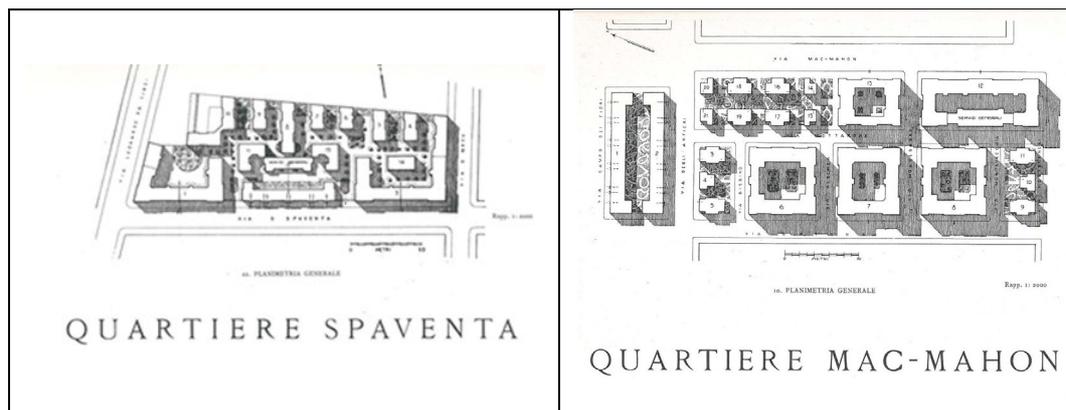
I Quartieri Spaventa e Mac Mahon. Planimetrie.
